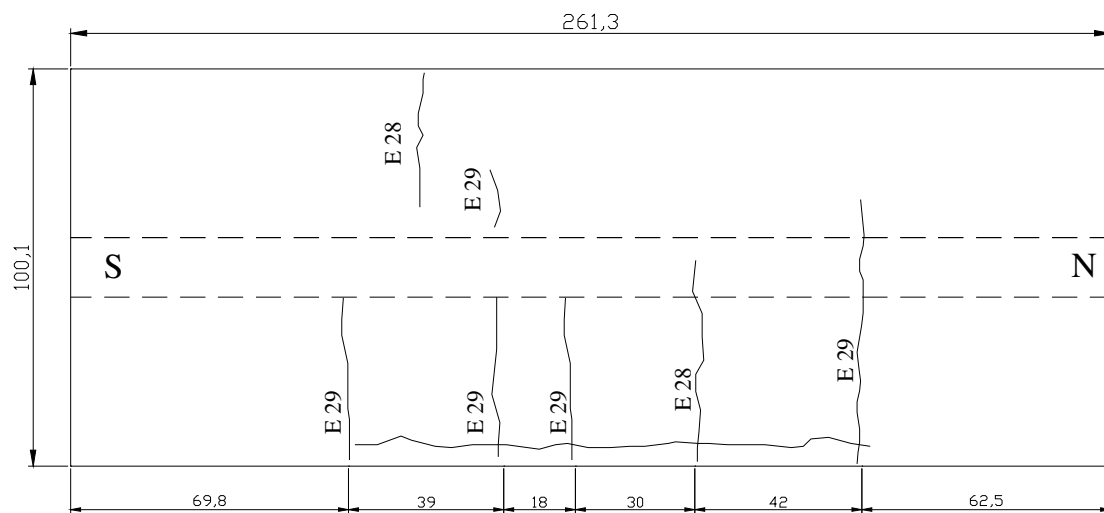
Fissuras do Modelo 2BE (Face superior da laje) – medidas em cm.
